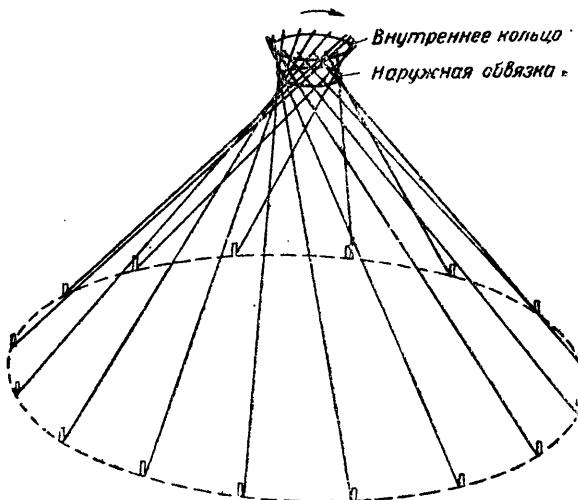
Сборка остова круглого шалаша. Закрепление жердевых ног
